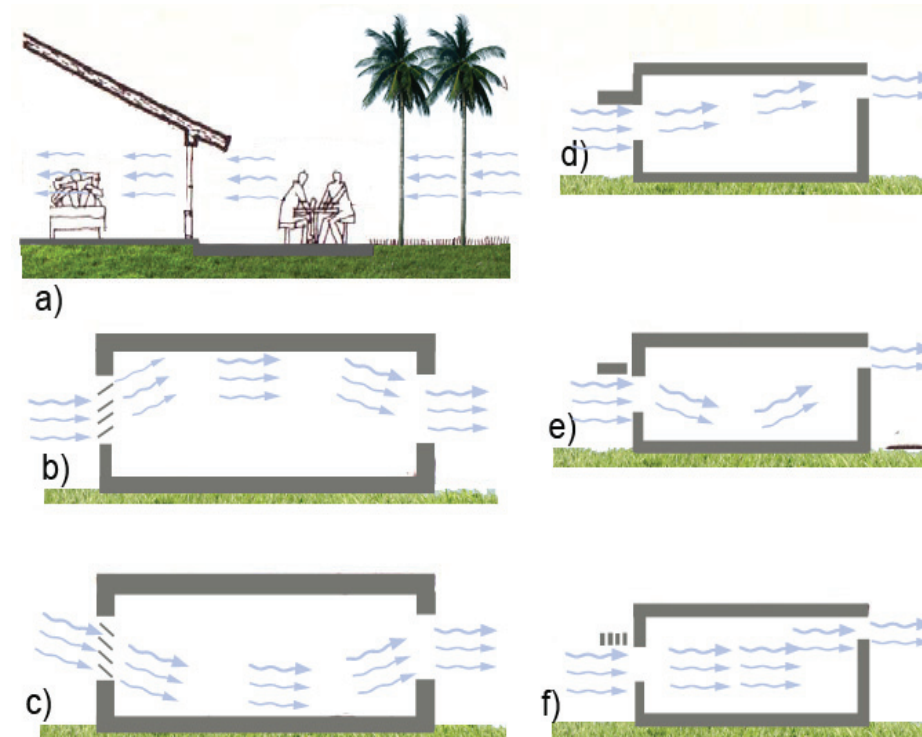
VIENTO Y APERTURAS ALZADOS
